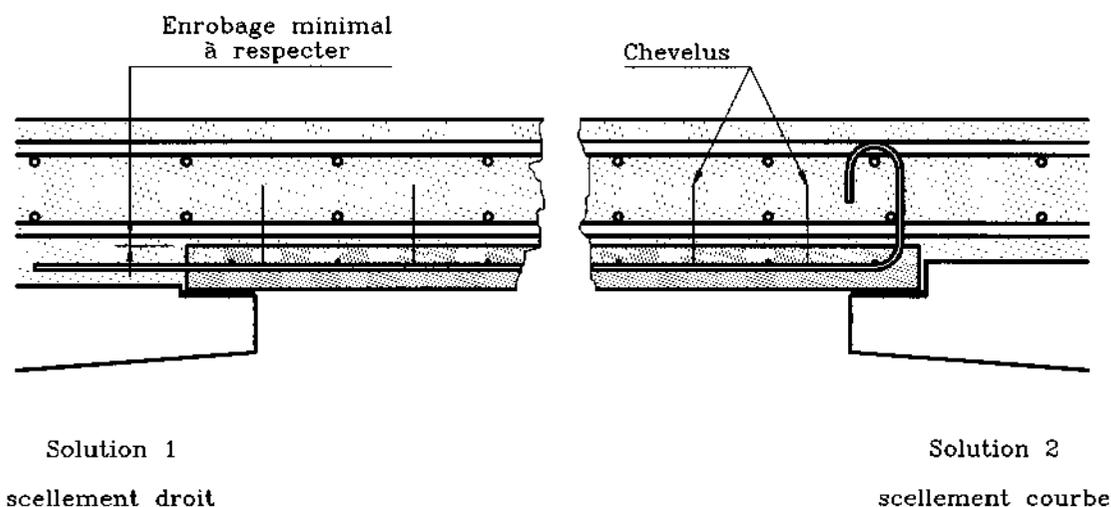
Principe de ferrailage du hourdis sur prédalle non participante
